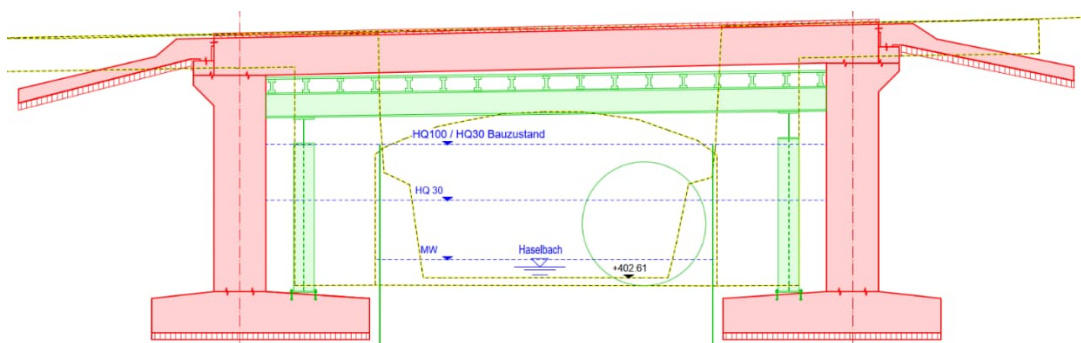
Aufbau Arbeits- und Lehrgerüst (nicht massstäblich).
